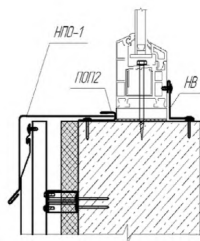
Примыкание к кровле. Вертикальный разрез
